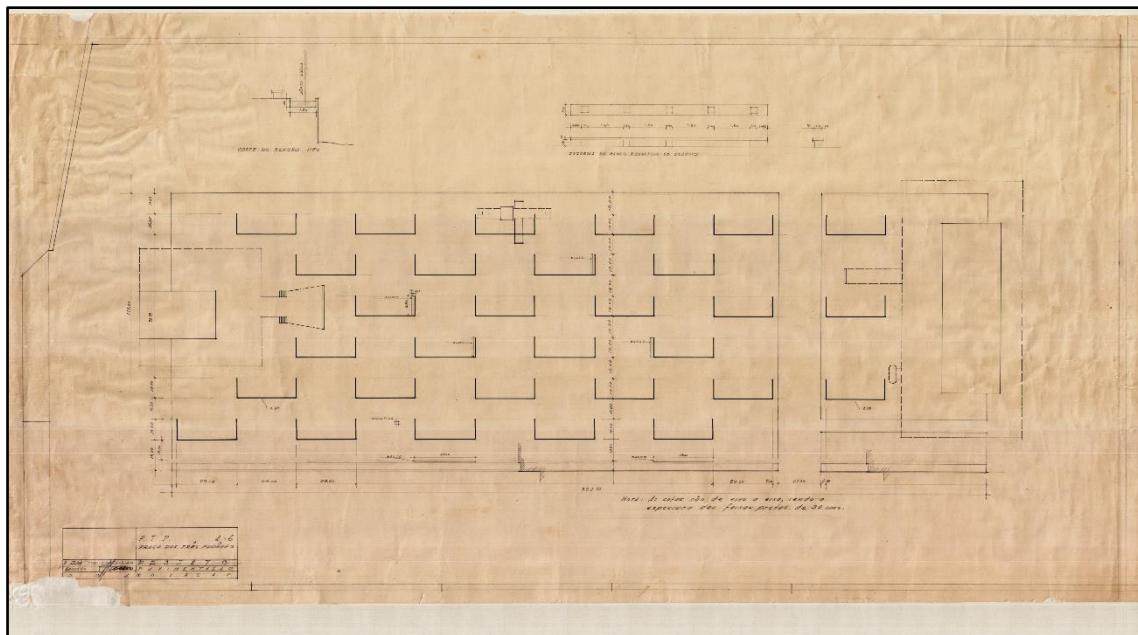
Fev. 1960 - Praça dos Três Poderes. PTP 4-6 Escalas 1:500 e 1:50 Projeto de Pavimentação D.U.A.-NOVACAP. Arquivo: PTP - URB - 000-0 - 004-06 - B002284 - 1960-02 - Projeto - Pavimentação. Fonte: SUPAC/SECULT-DF.
